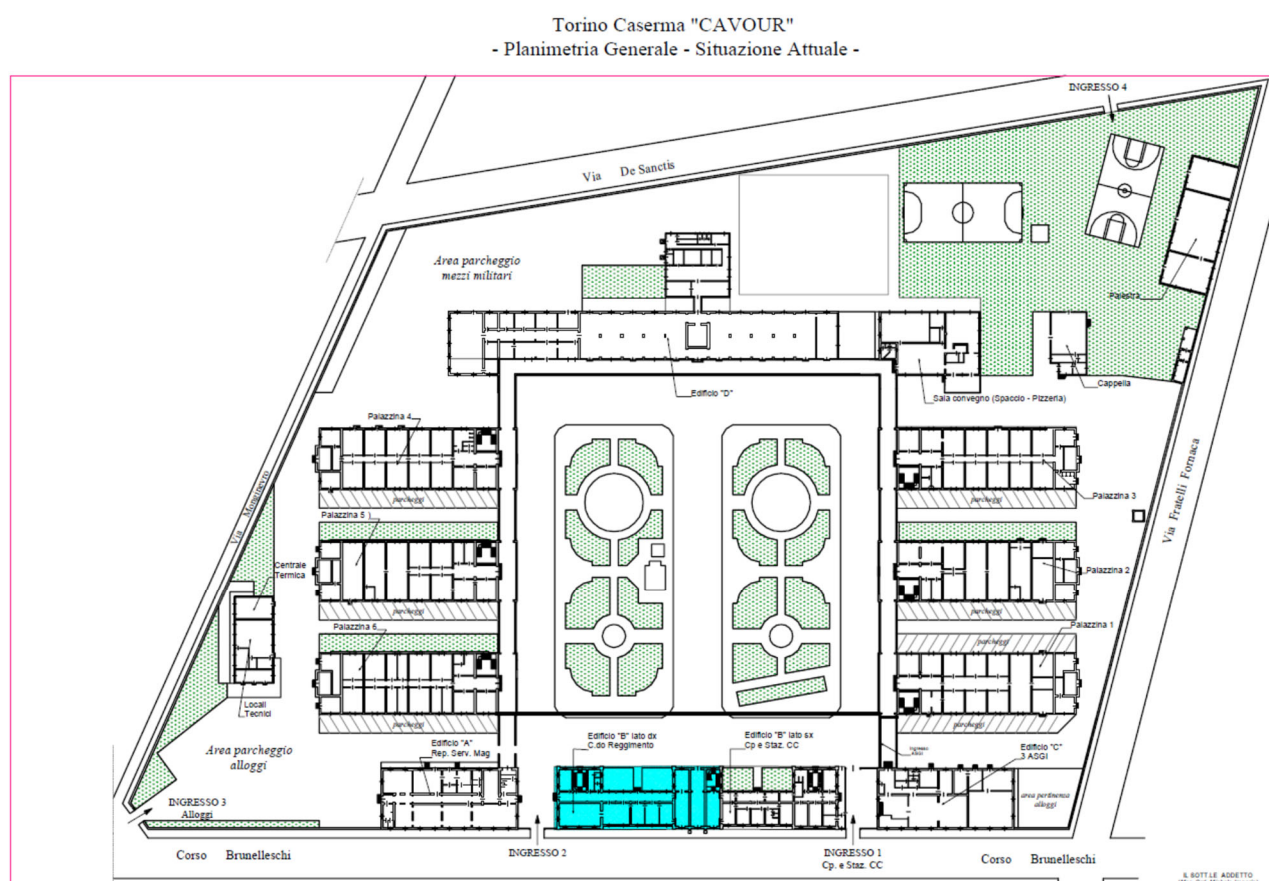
Planimetria con individuazione della porzione dell'Edificio "B" che sarà occupata dai nuovi Reparti
